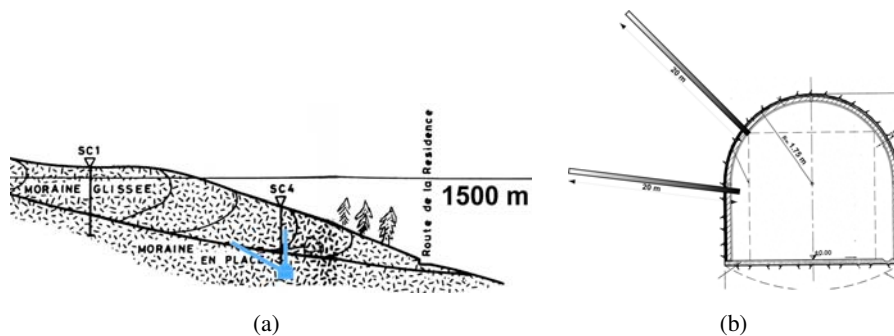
Längsschnitt durch die Rutschung La Saussaz mit skizziertem Drainagetunnel und Bohrungen (a); Skizze Querschnitt Drainagetunnelprofil und Drainagebohrungen (b).
